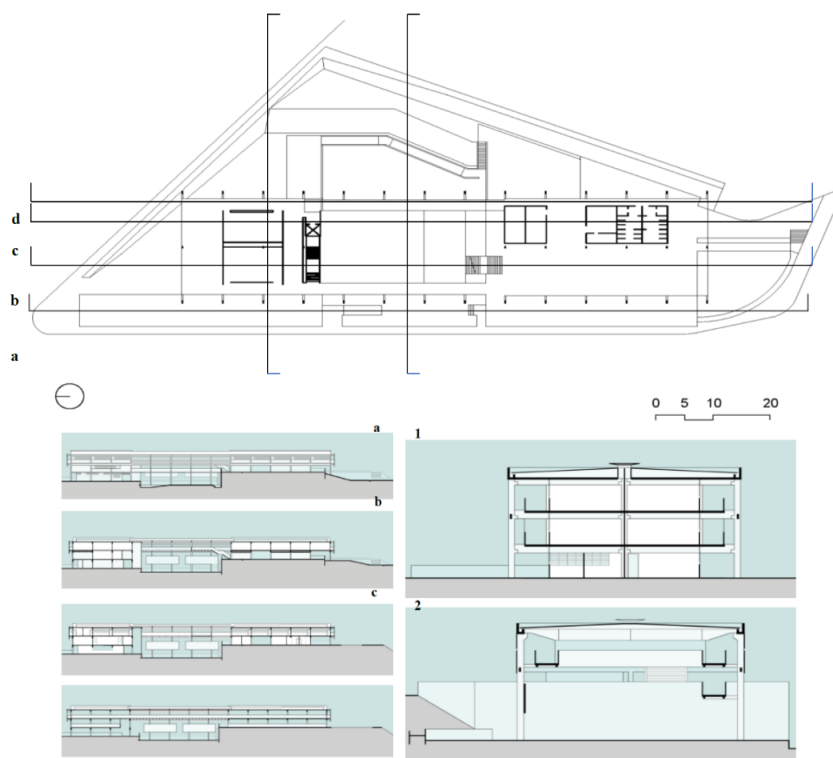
Planta baixa do 1º Pavimento com a simbolização das linhas de cortes – transversais e longitudinais – para permeabilidade e Desenvolvimento dos vazios transversais
